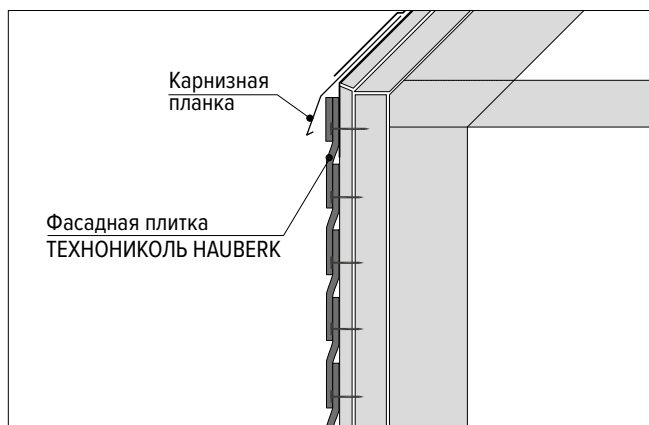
Монтаж верхнего ряда в домах без карнизного свеса
